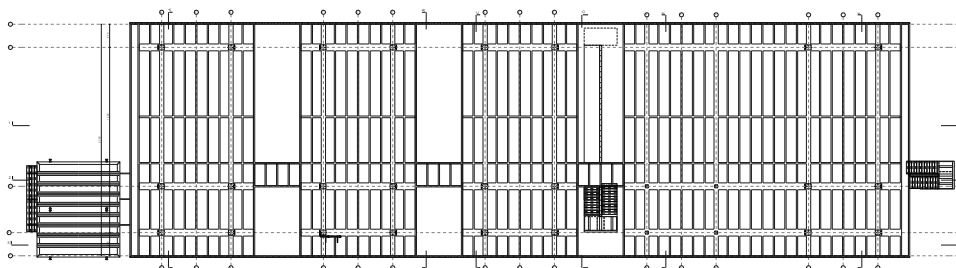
Vista en Planta Baja de la Estructura del Edificio.
